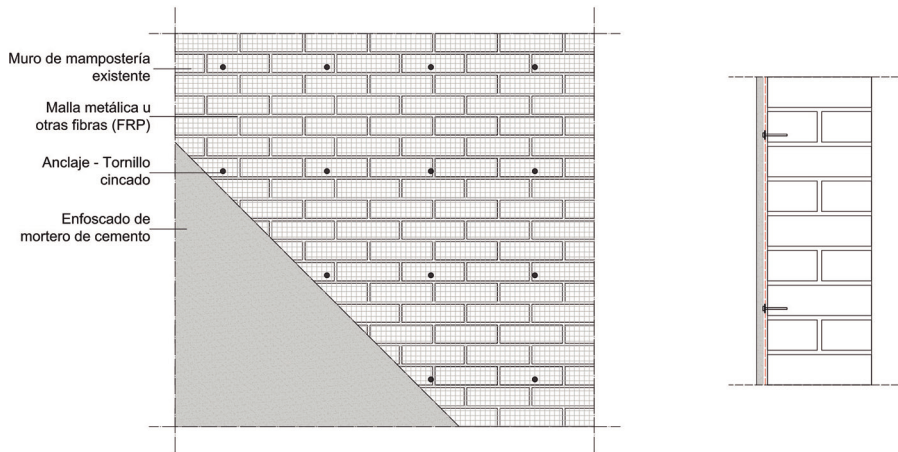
Ferrocemento. Esquema y detalle constructivo.
